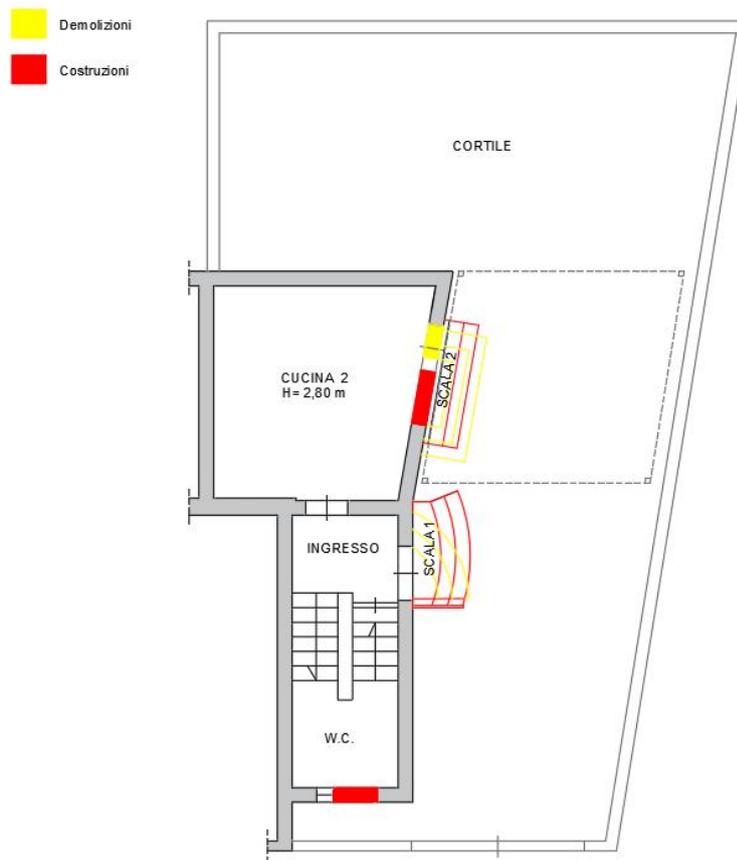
Confronto edilizio - Planimetria Piano Terra
